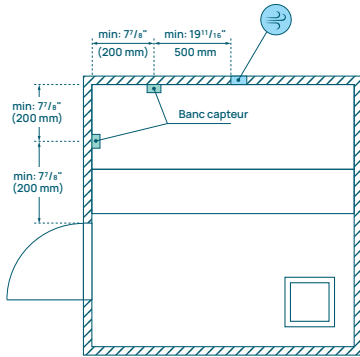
Installation du capteur de sécurité au plafond : chauffage mural.
